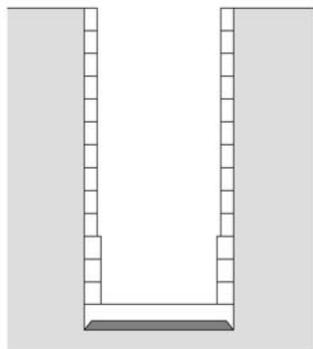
非常口の施工概要 (ケーソン工法の場合)
